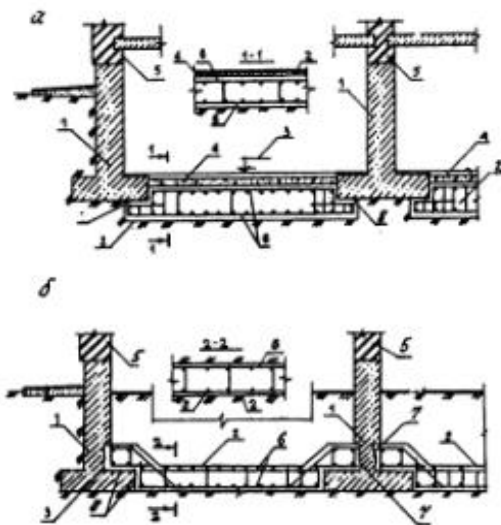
Переустройство ленточных фундаментов в плитные: а - с расположением плиты ниже фундаментных подушек; б - то же, в уровне подушек со шпоночными связями; 1 - усиливаемый ленточный фундамент; 2 - сплошная монолитная железобетонная плита; 3 - отметка поверхности пола подвала; 4 - уплотненный крупный песок; 5 - кладка стен подвала; 6 - рабочая арматура плиты; 7 - пазы в фундаментной ленте для устройства шпоночных связей с плитой; 8 - поверхность фундамента, подготовленная к бетонированию
